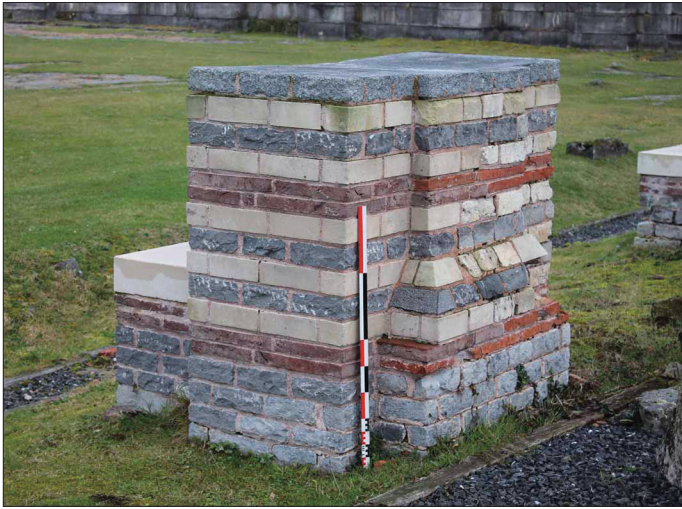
Face interne du pilier PTS06 reconstruit à l'identique (fait architectural 31 ; technique B) dans le portique sud de l'esplanade (cliché : C. Louvion).
